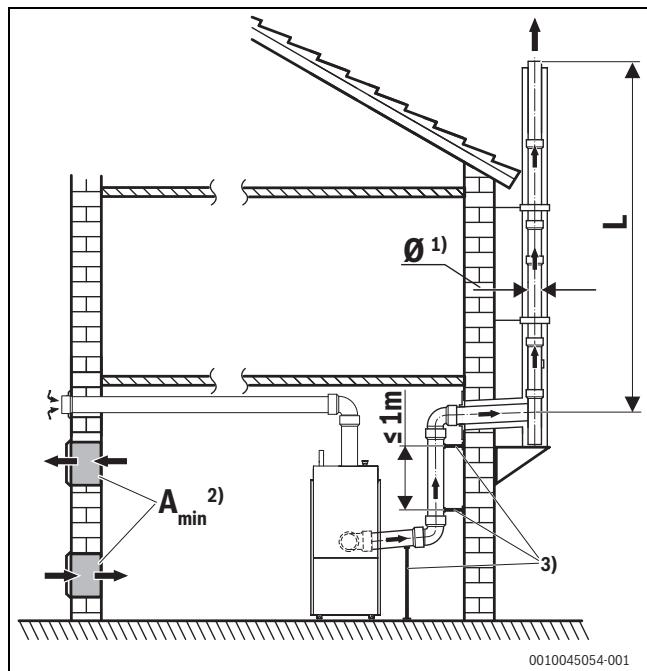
Wirksame Höhe der Abgasleitung, ohne Schacht, Fassadensystem, Variante 4
